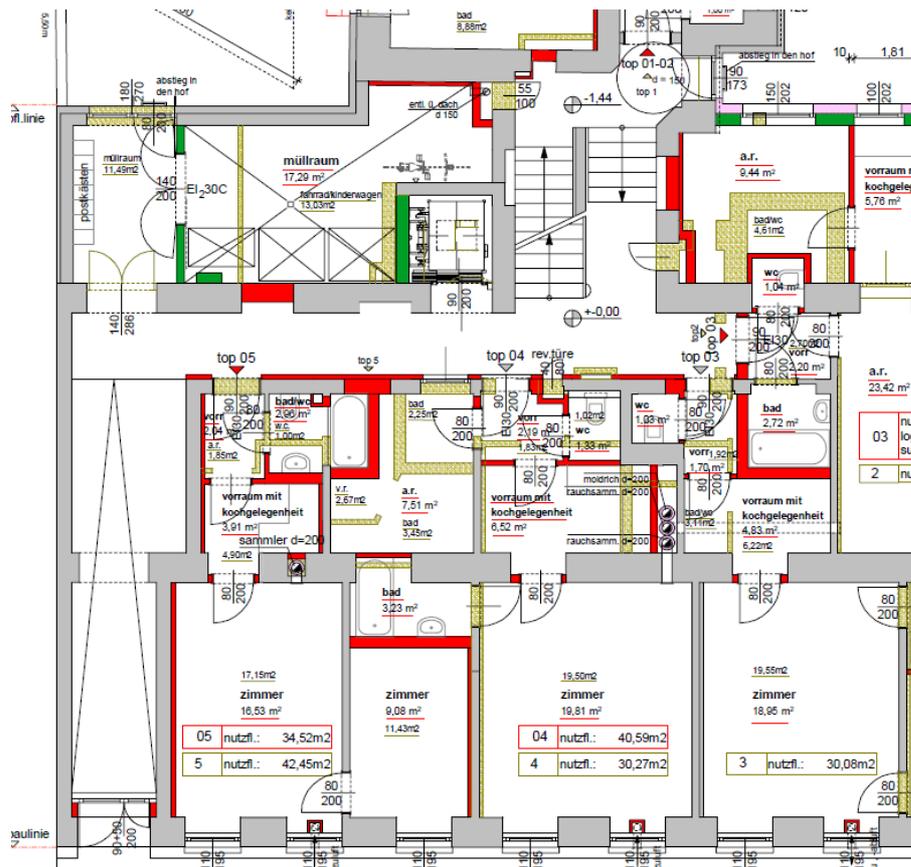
Wißgrillgasse 10, Grundriß Erdgeschoß, Ausschnitt mit Hauseingang und Müllraum (Quelle: Ulreich)
